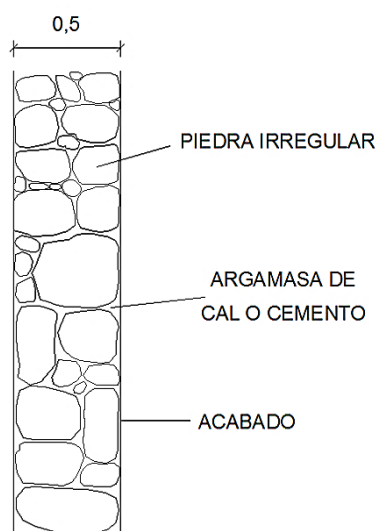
Posible sección constructiva del muro. Fuente: Autora
